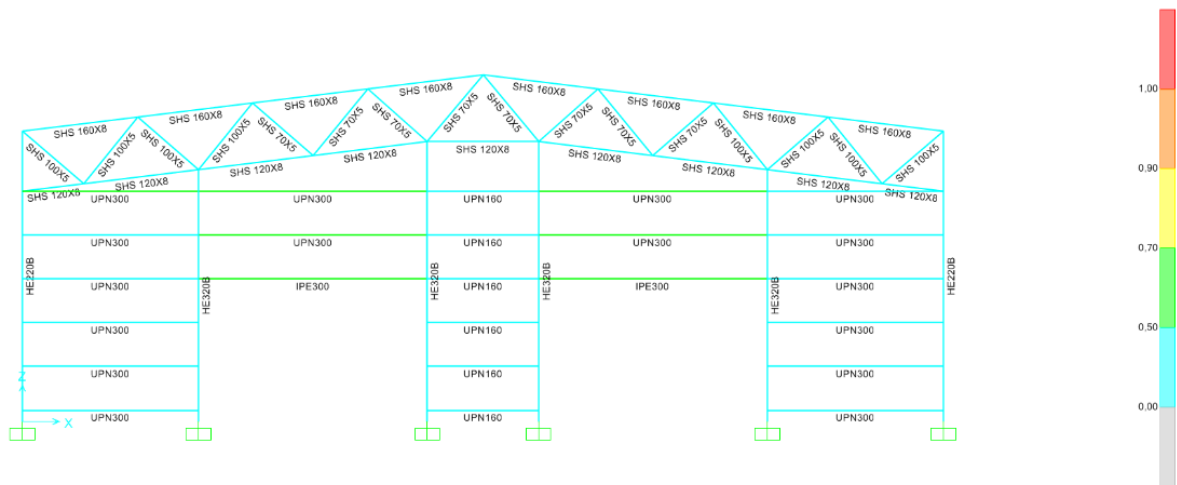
aprovechamientos pórtico fachada 2 (y=84)
